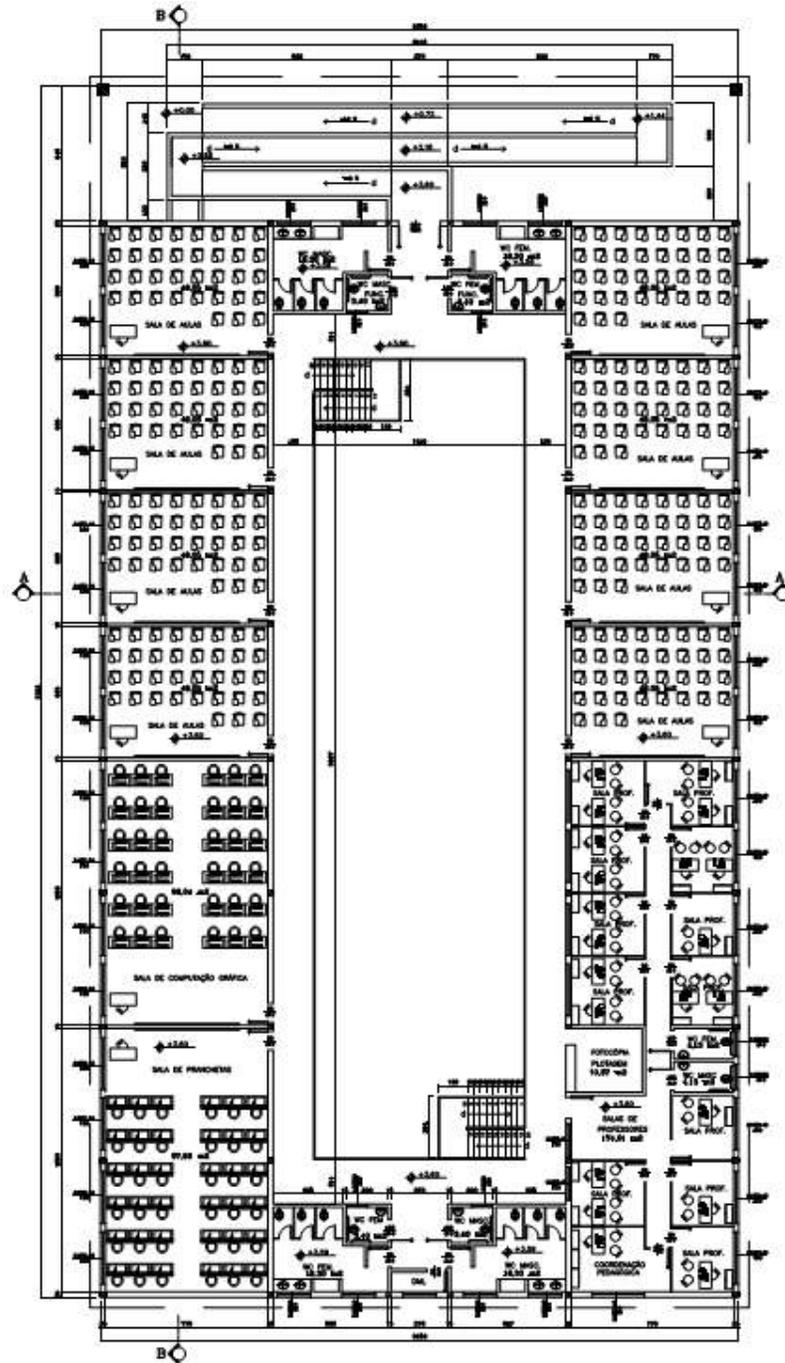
Planta Baixa do Pavimento Superior do Bloco de Edificações.
